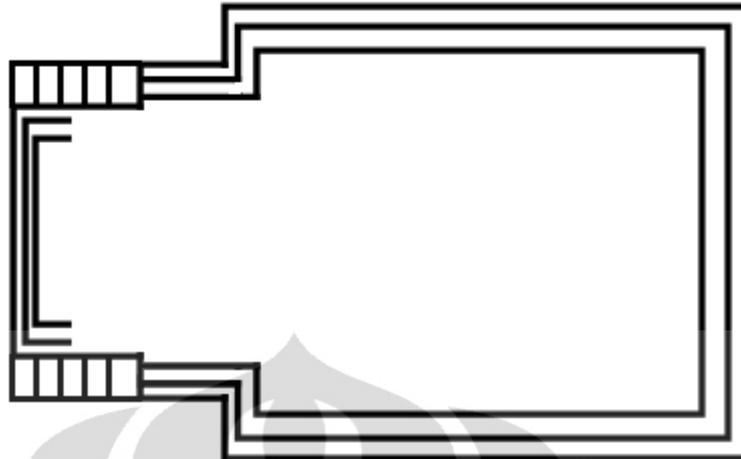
Pondasi Sumuran pada Candi Tepas
